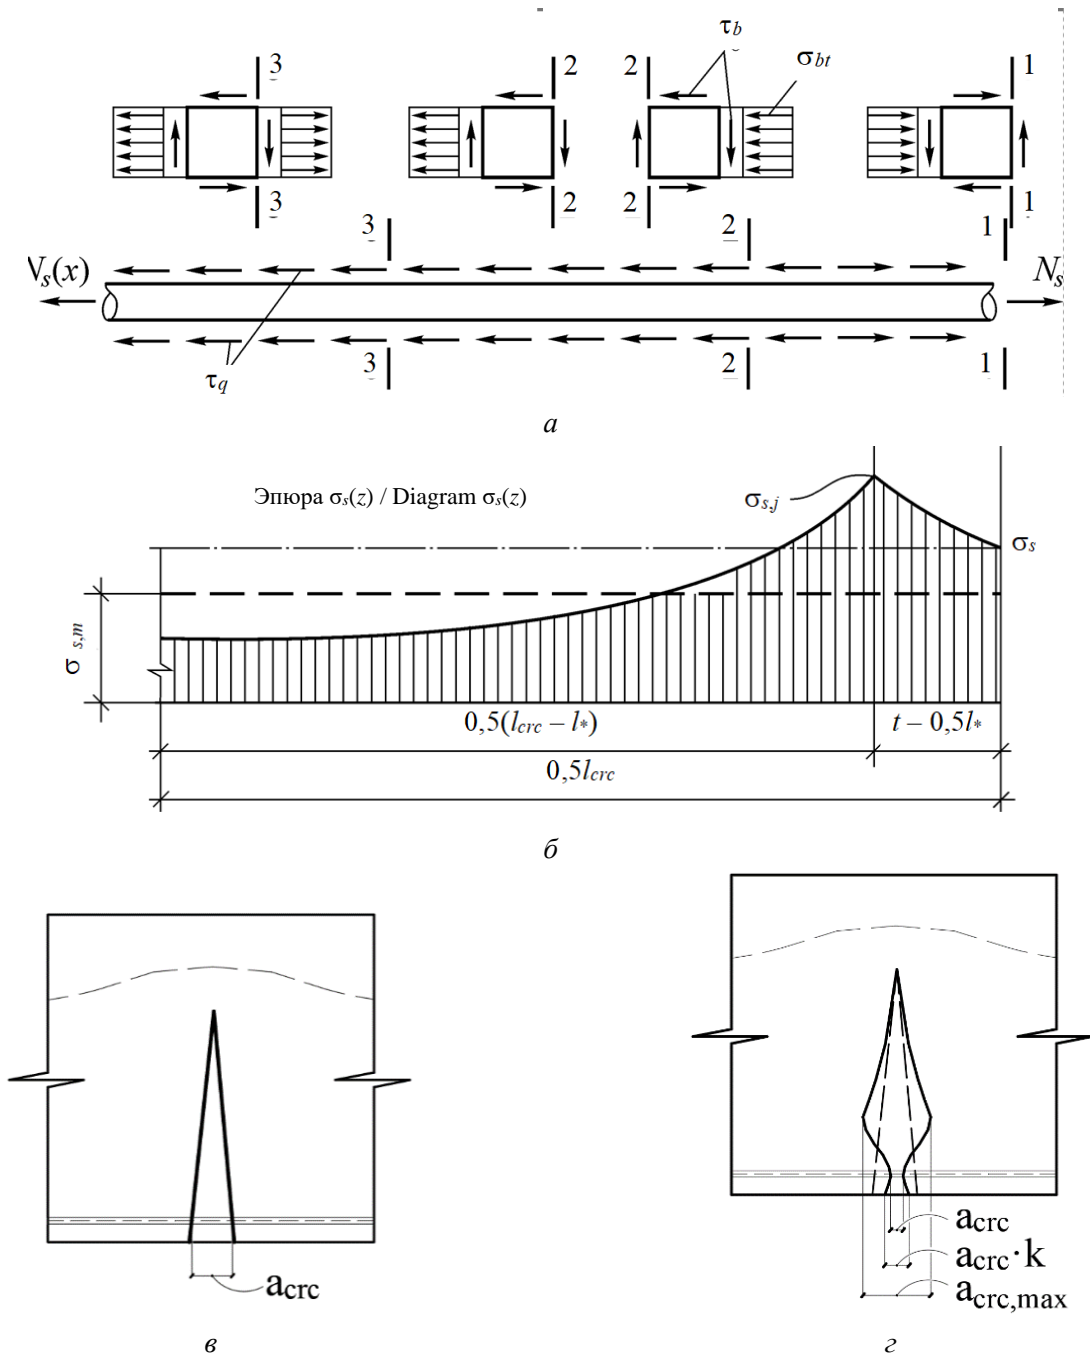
Схемы деформационного эффекта железобетона от воздействия реакции «бетон – арматура» при нарушении сплошности бетона:
